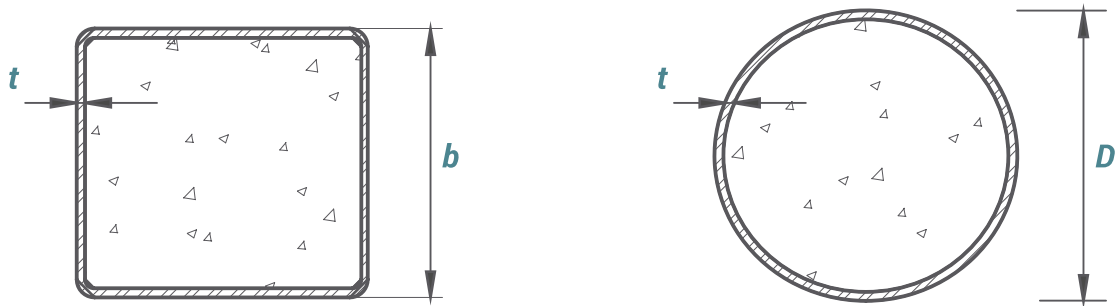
Columnas compuestas acero-concreto perfiles rellenos de concreto.
